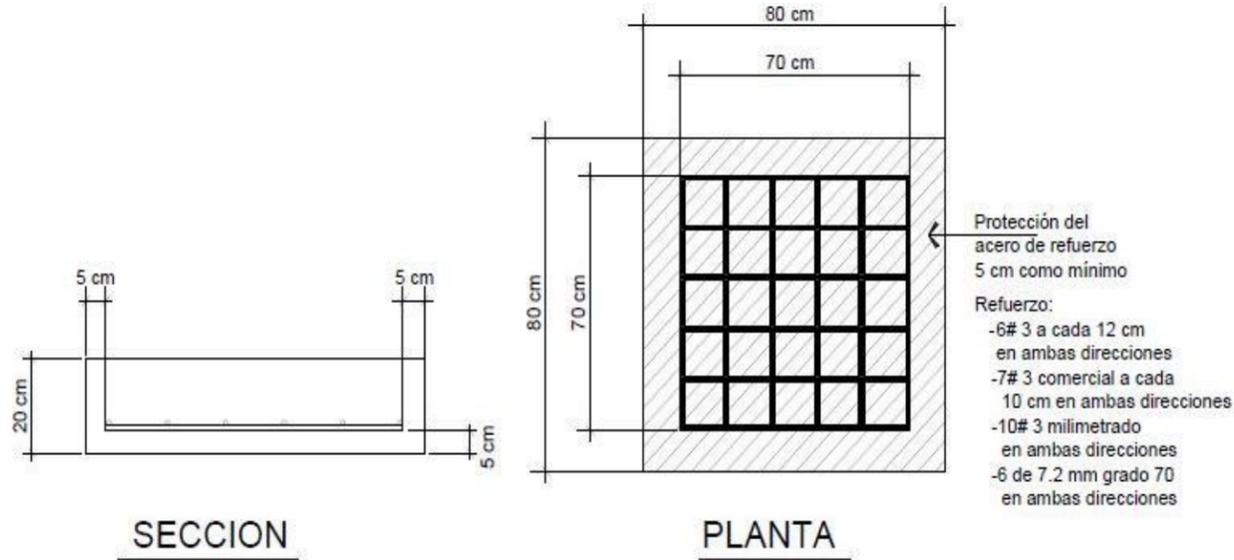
Detalles de sección y planta de zapata aislada. Fuente: equipo de trabajo
